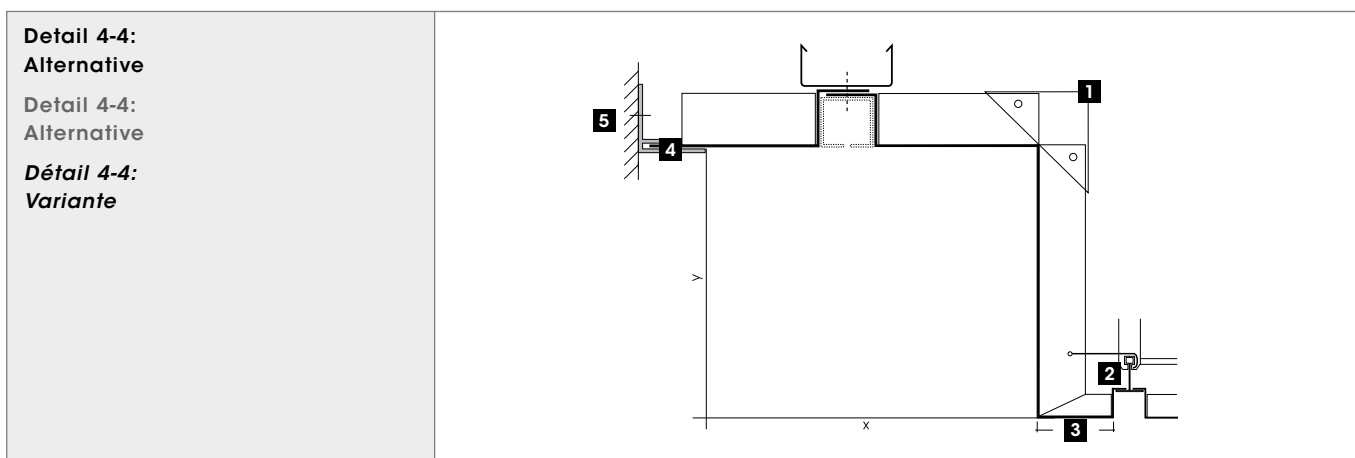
DETAILS-WANDANSCHLÜSSE DETAILS-WALL CONNECTIONS DETAILS CONNECT. MUR
